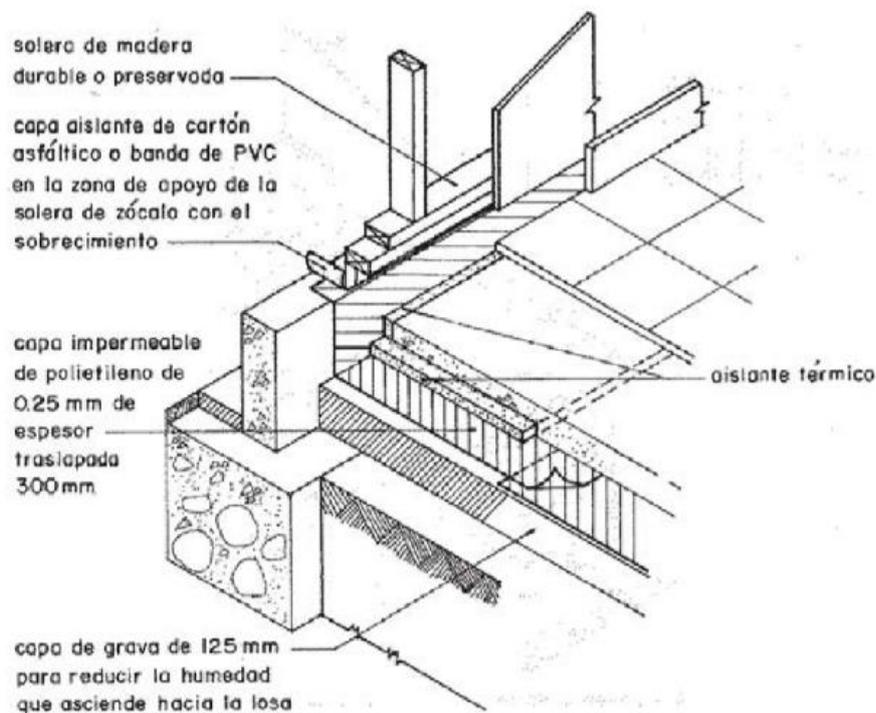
Detalle de cimentación, para protección de la humedad del suelo
